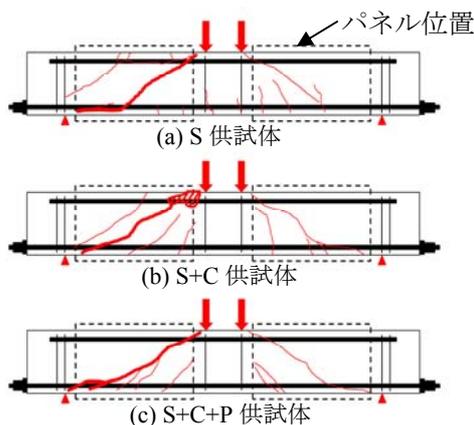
ひび割れ状況(太線は顕著なもの、斜線部はコンクリート圧壊部分)
